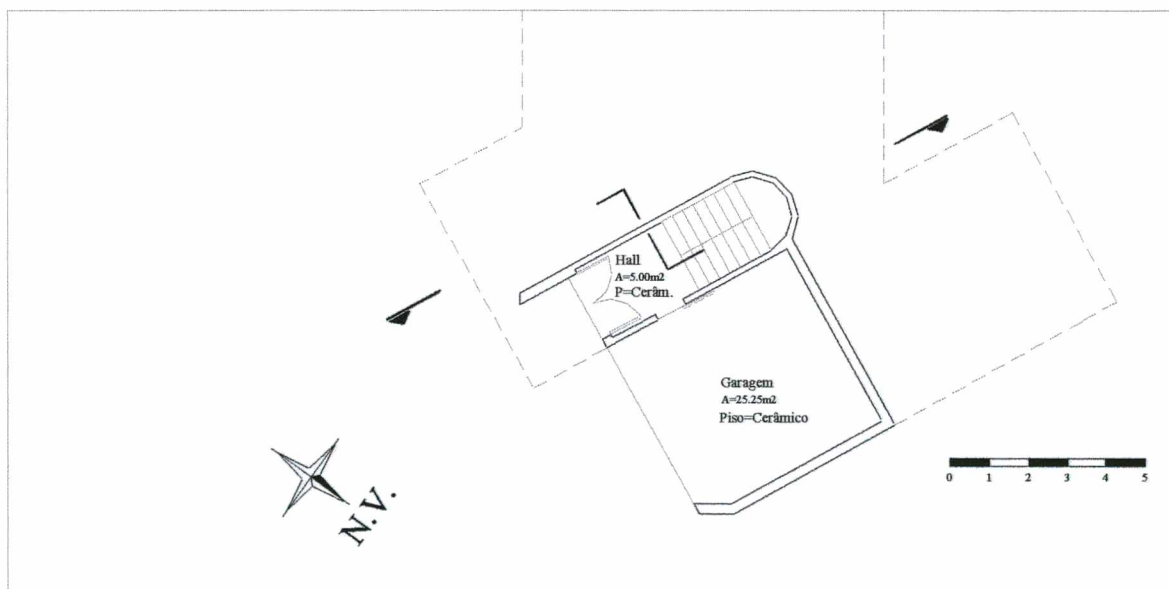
Planta Baixa Pavimento Garagem Residência 1
